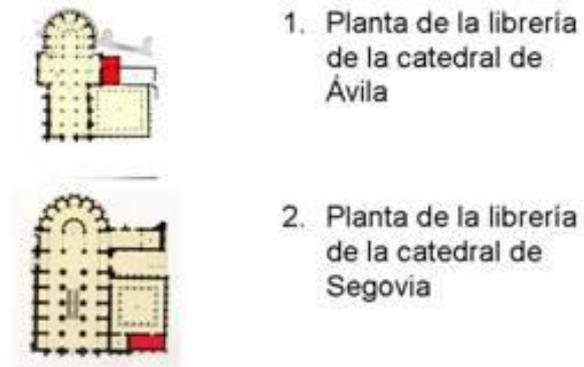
Planta de las librerías de las catedrales de Ávila y Segovia.
